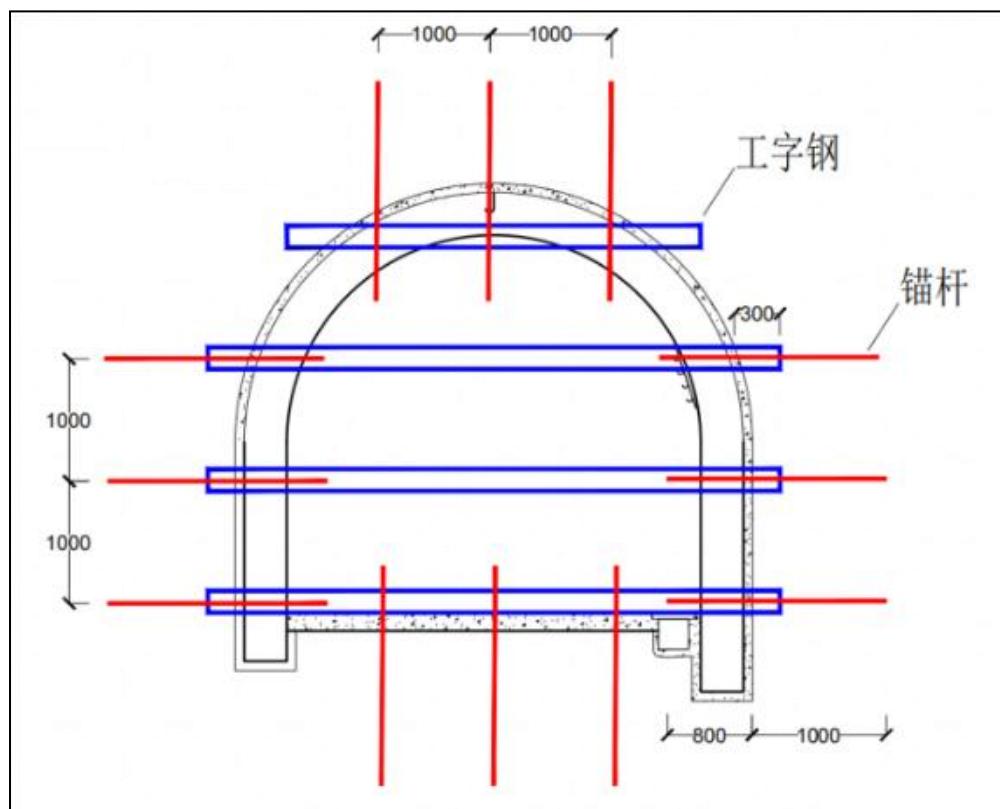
井筒封闭设计横断面示意图（图中标注尺寸单位为 mm）
